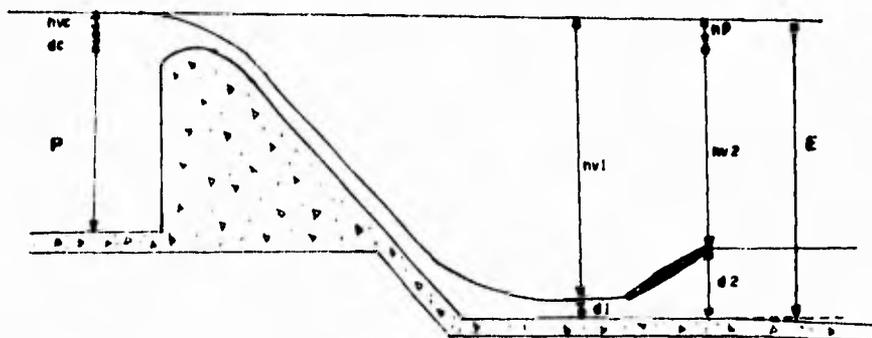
DETERMINACION DE LA SECCION DE CONTROL
